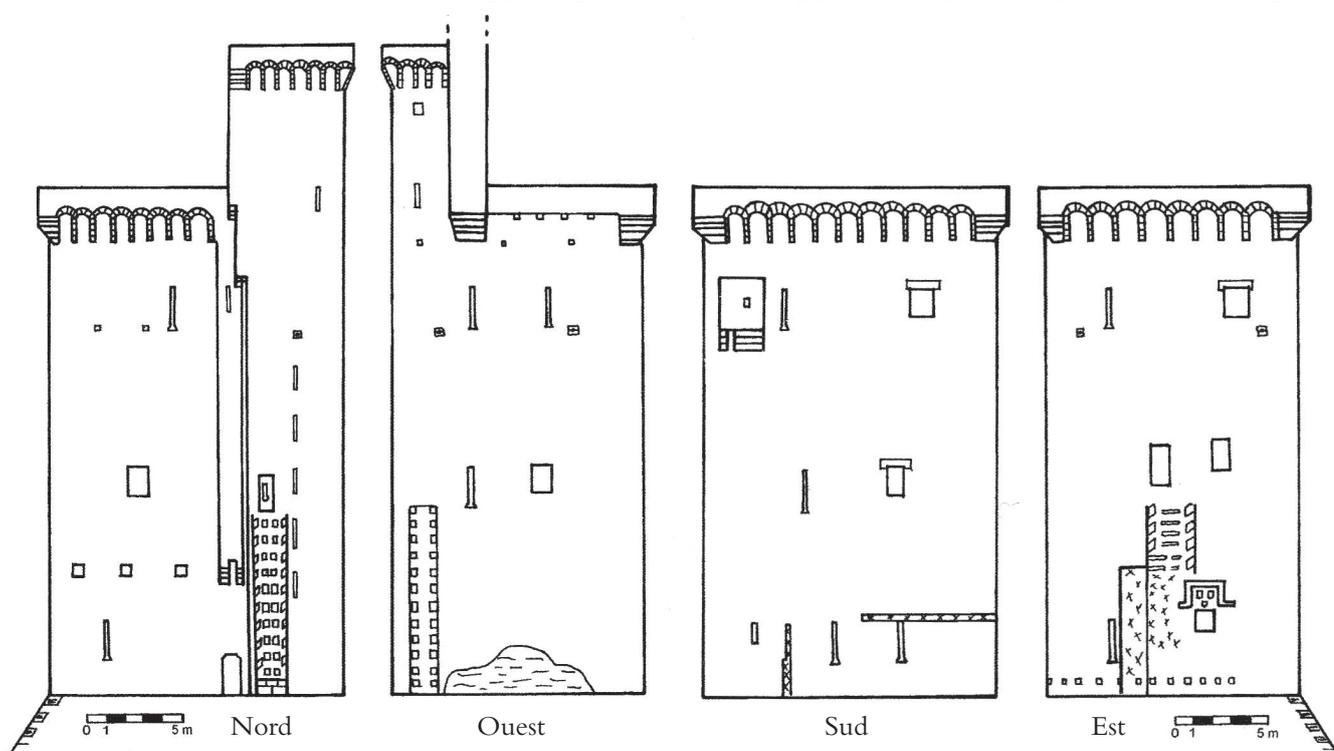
tour du pont d'Avignon. Élévations (relevés et dessin : C.M.)
